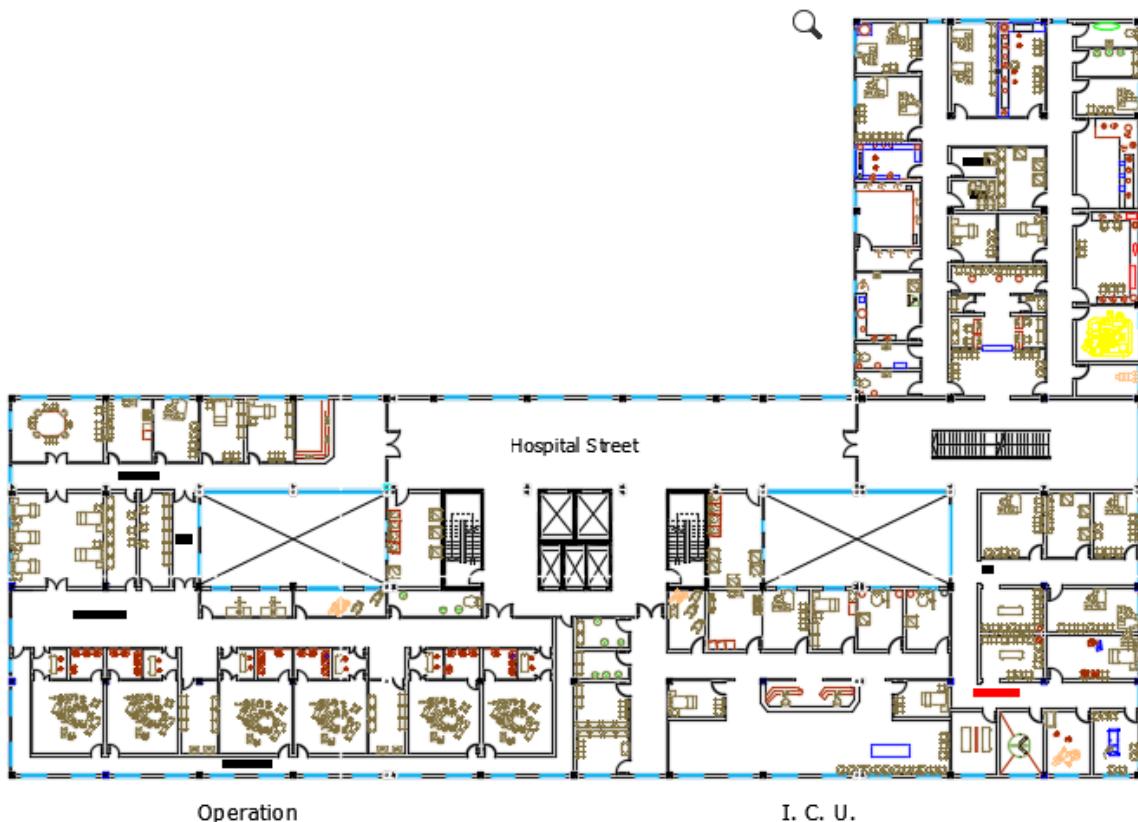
المسقط الأفقي للطابق الأرضي.
